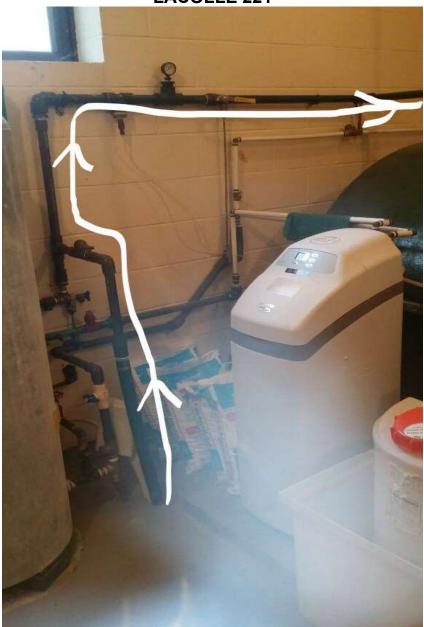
cheminement de l'eau et installations du poste frontalier de Lacolle 221
